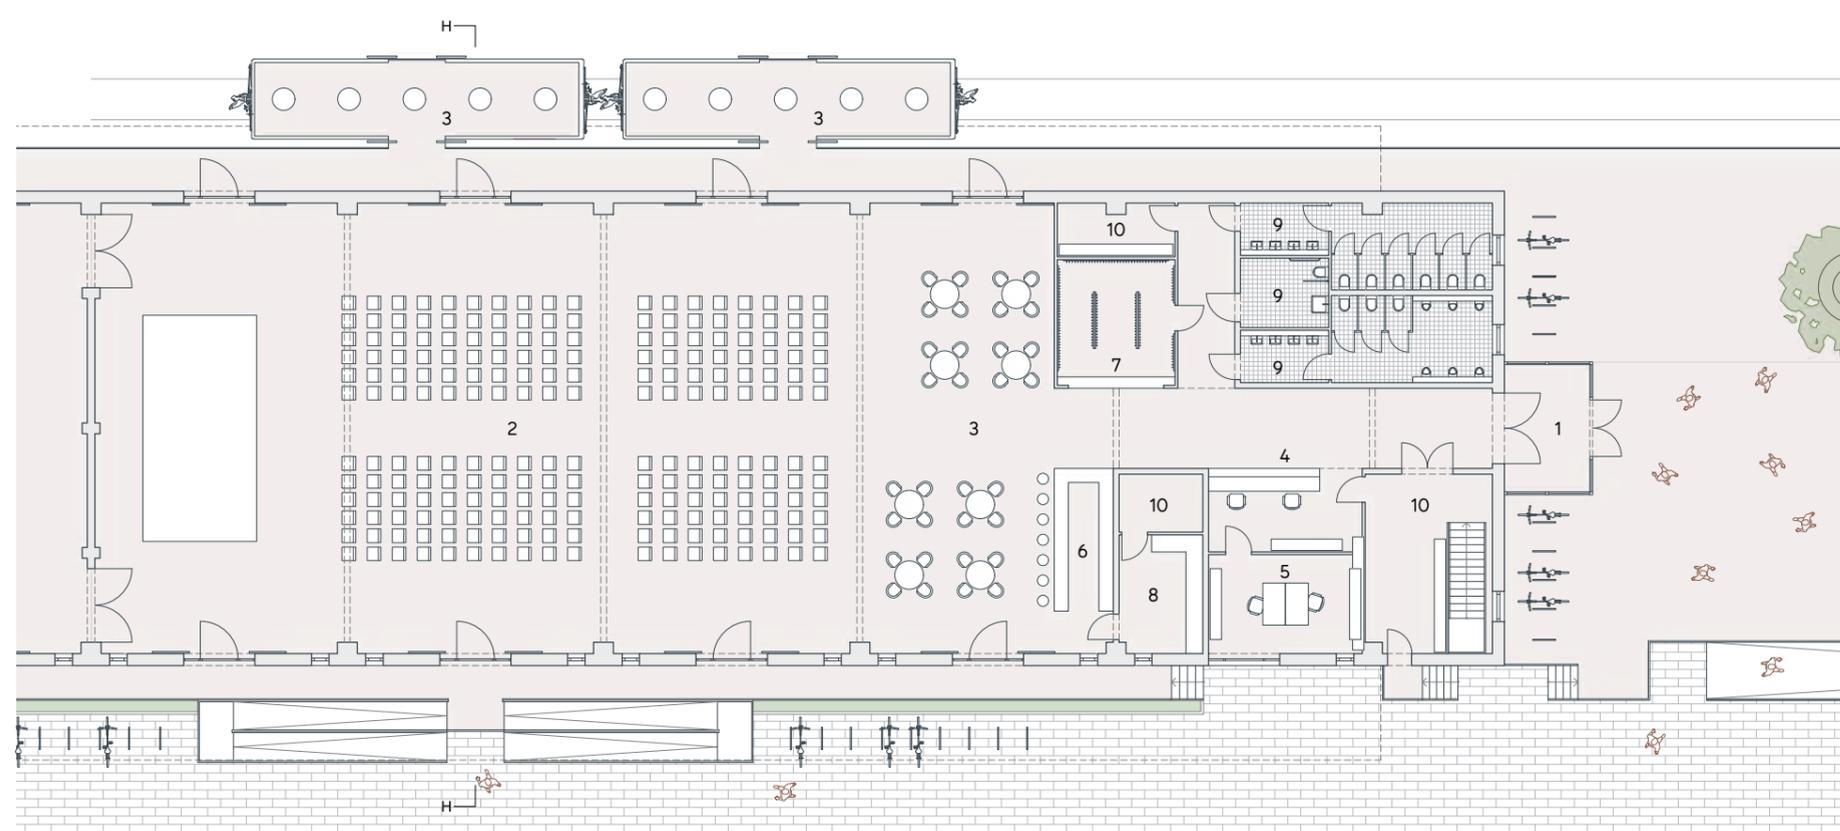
Stückgutschuppen: Veranstaltungshalle, Halle 3, Erdgeschoss M 1:250
